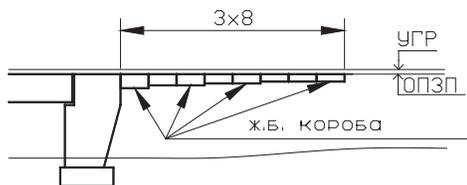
Конструкция УПЖ с железобетонными коробами.
